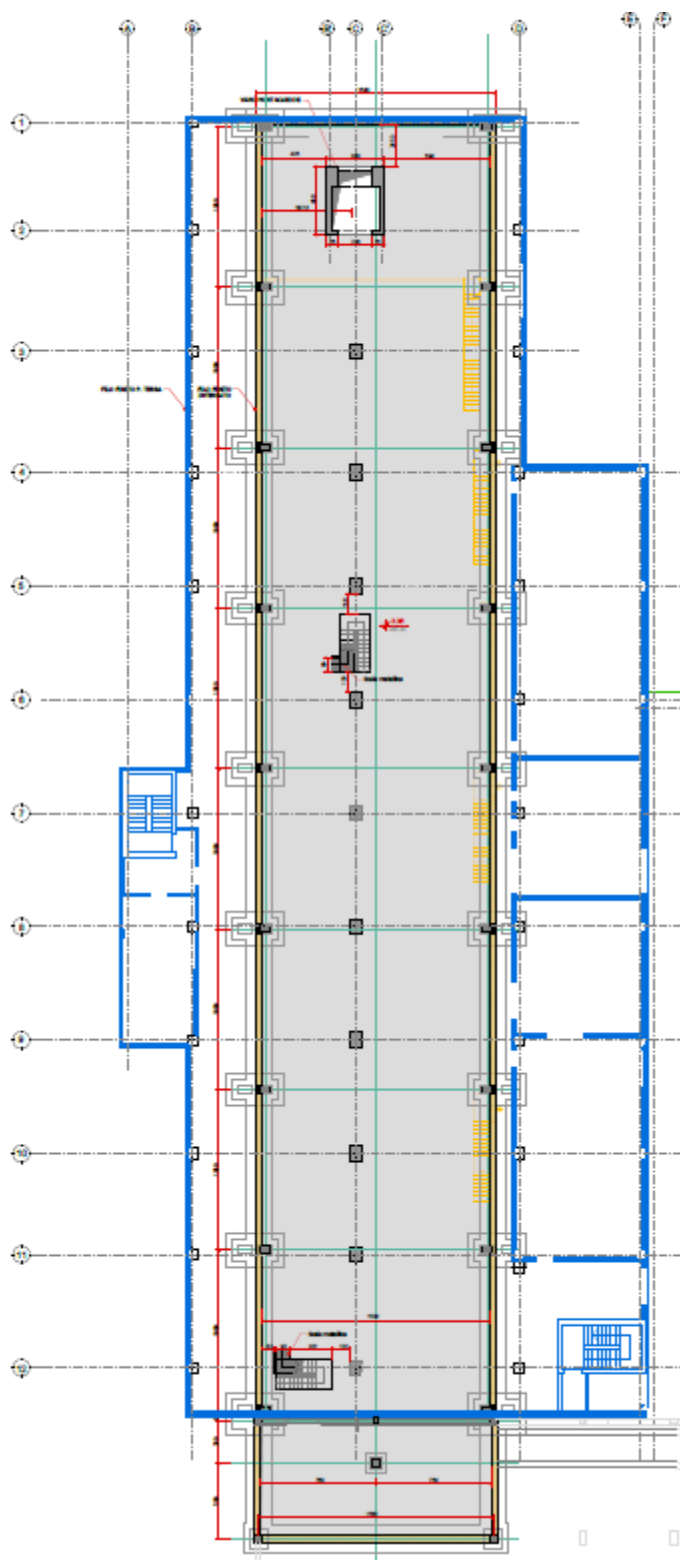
Planimetria architettonica piano P-1 - Fabbricato Ex. Piemonte
